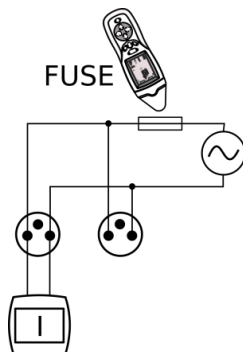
Modalità di localizzazione delle protezioni dell'impianto FUSE
